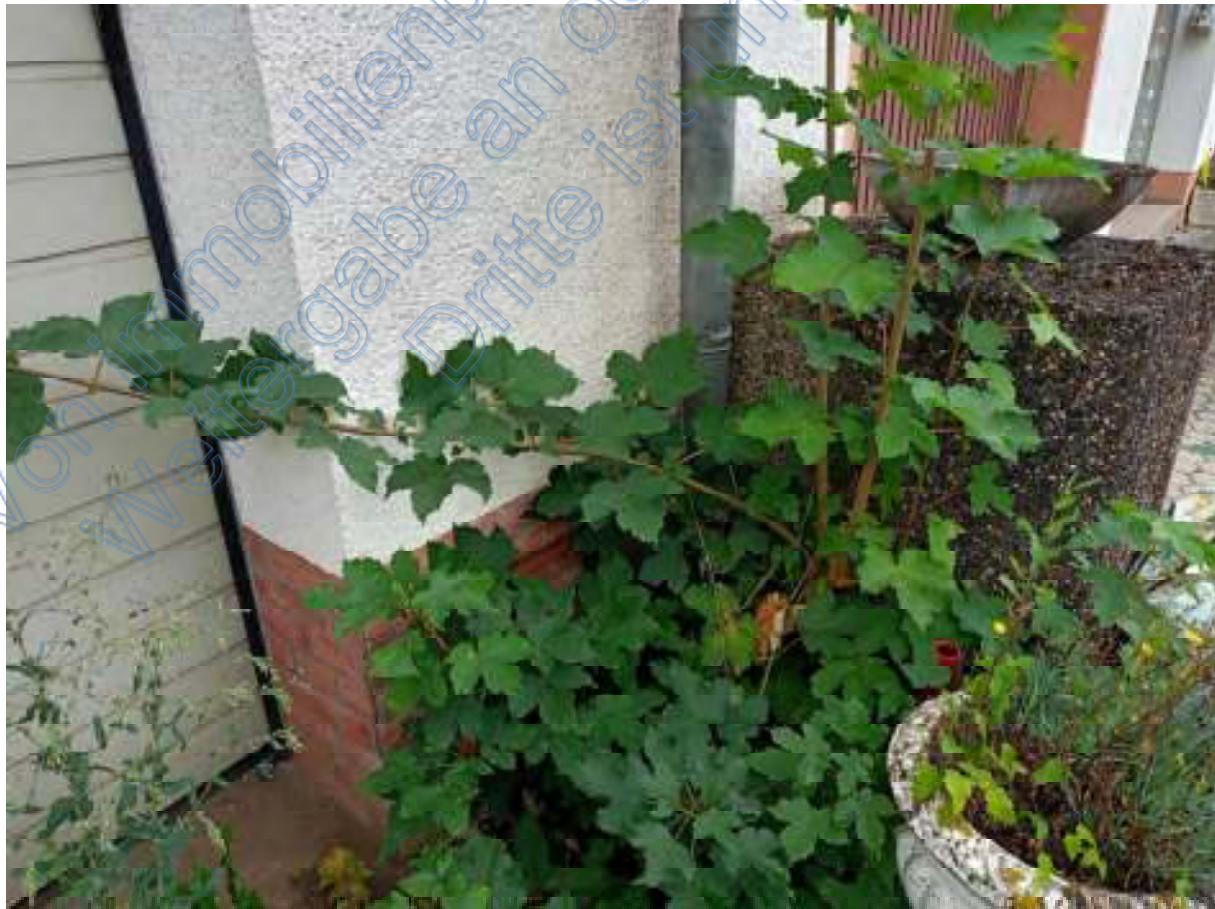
Entwässerungssituation des Daches an der straßenzugewandten Fassade von Gebäudeteil A
